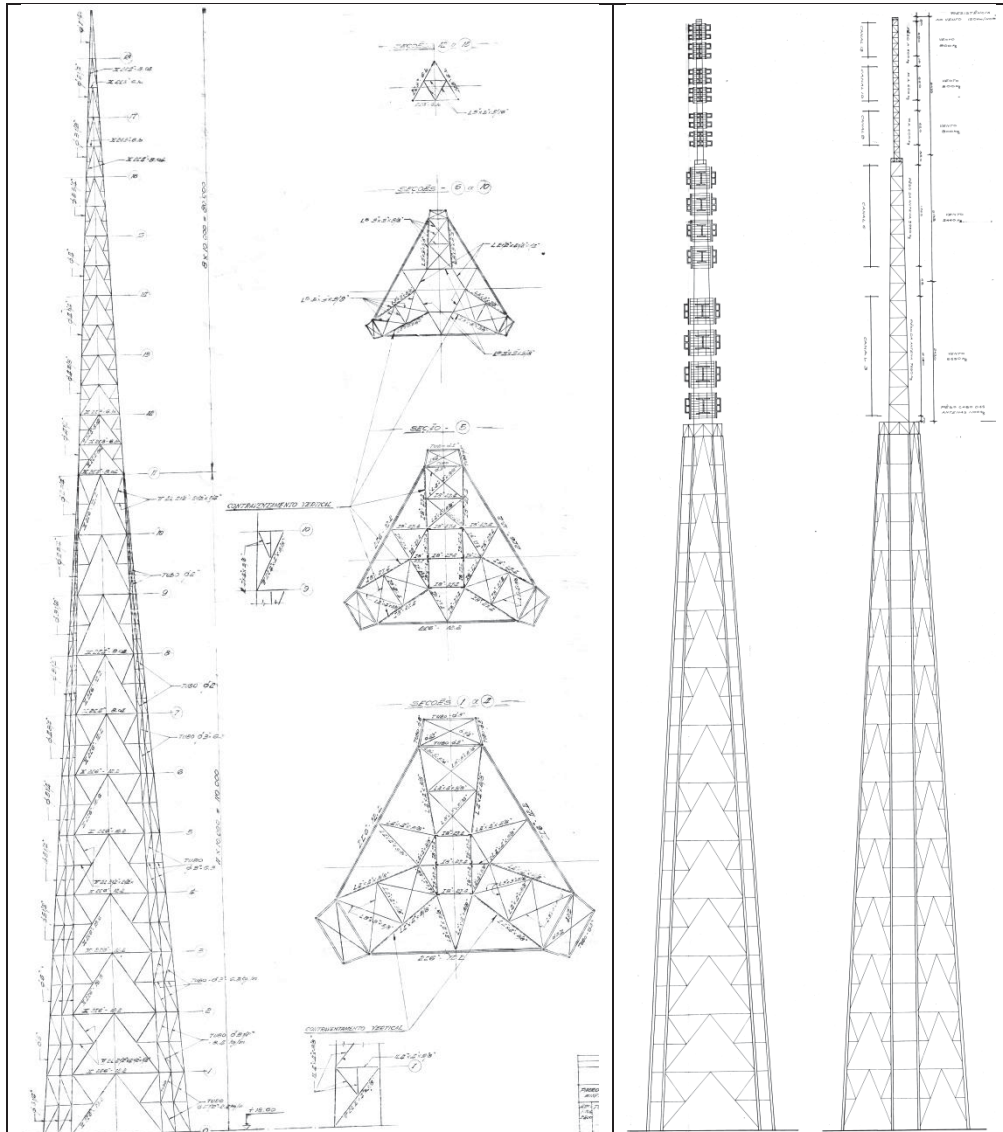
Vista da primeira proposta da estrutura metálica da Torre (E) e o desenho final desenvolvido pelo engenheiro Paulo Fragoso (D) (Fonte: ArPDF)
